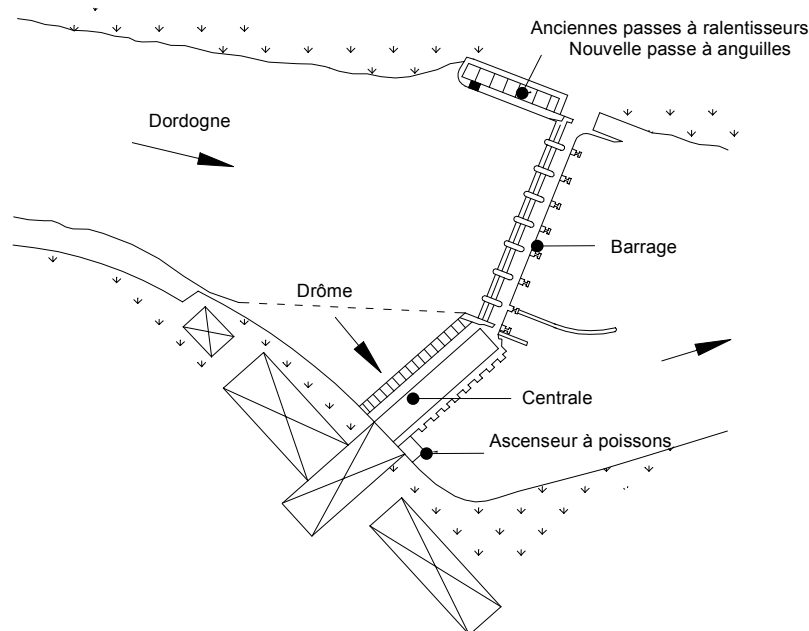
Localisation de la passe à anguilles sur le site de Tuilières
